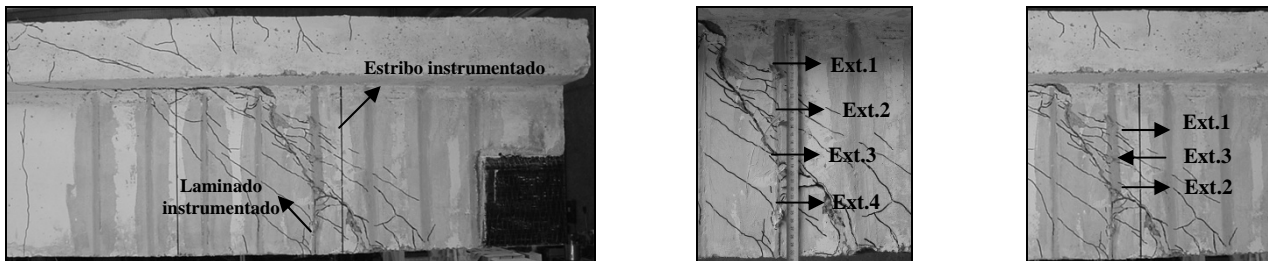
Localização dos extensómetros no laminado e estribo instrumentados da viga 2S-8LV-A.
